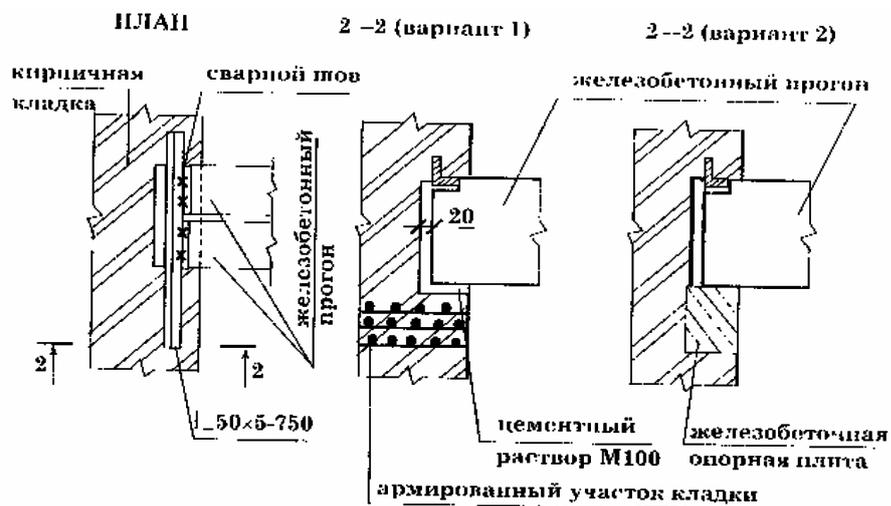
Опирание прогона на кирпичный столб (стену) или на армированные ряды кладки
